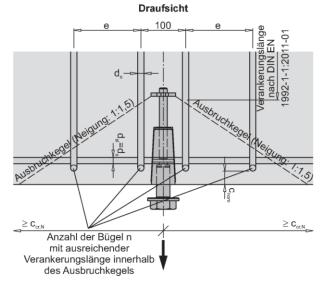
Einbausituation Stirnseite - Zugbeanspruchung mit Rückhängebewehrung - Bewehrungslage
